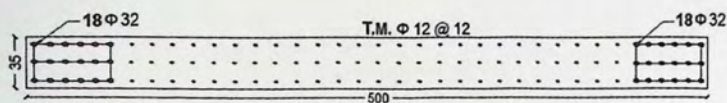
Sección transversal Muros 1 y 2, Edificio B
